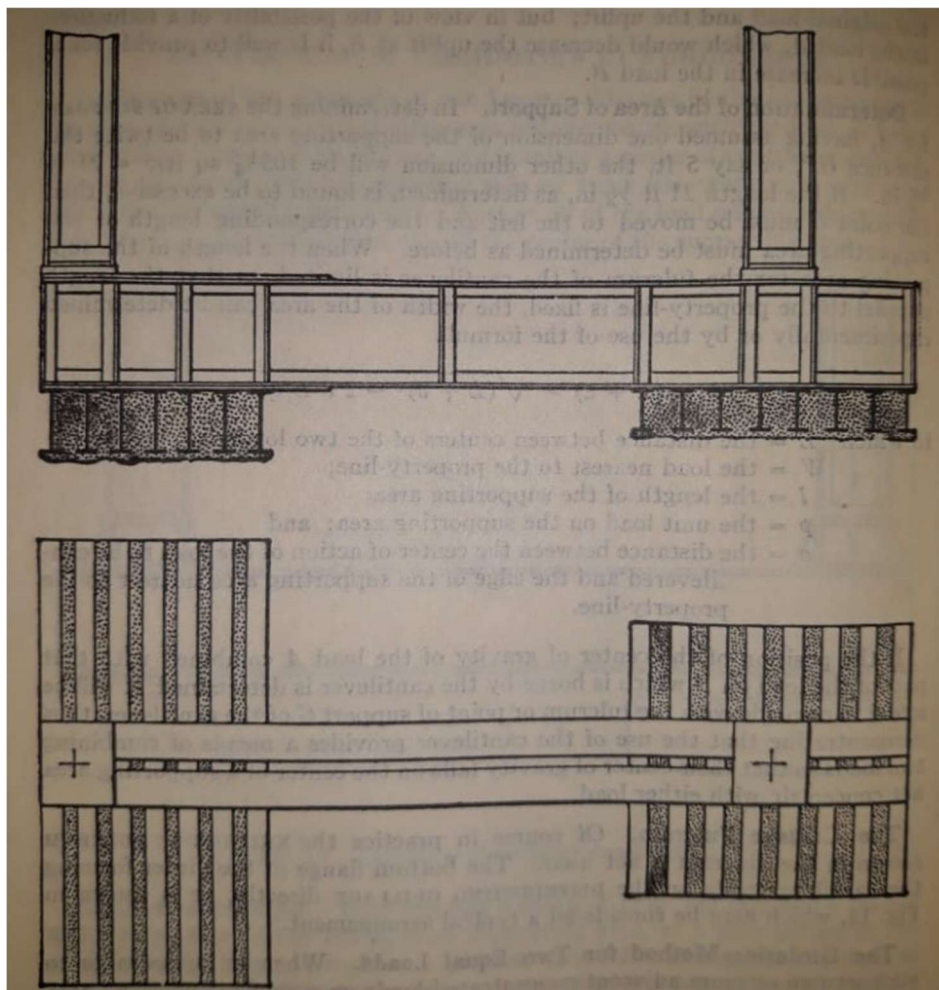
Sapata com viga alavanca com vigas mistas de aço e concreto [7].
